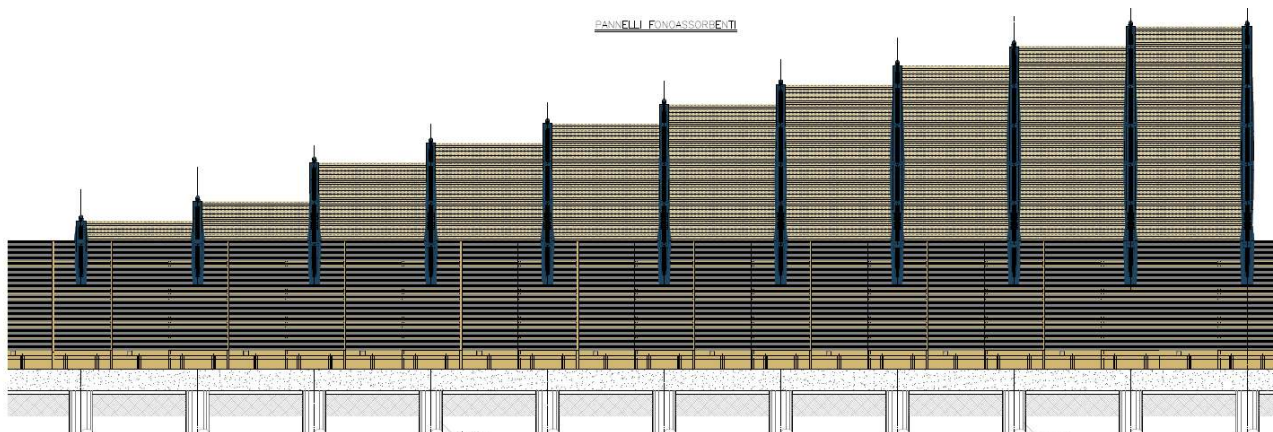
Prospetto delle barriere con i moduli di altezza variabile da H0 a H10
